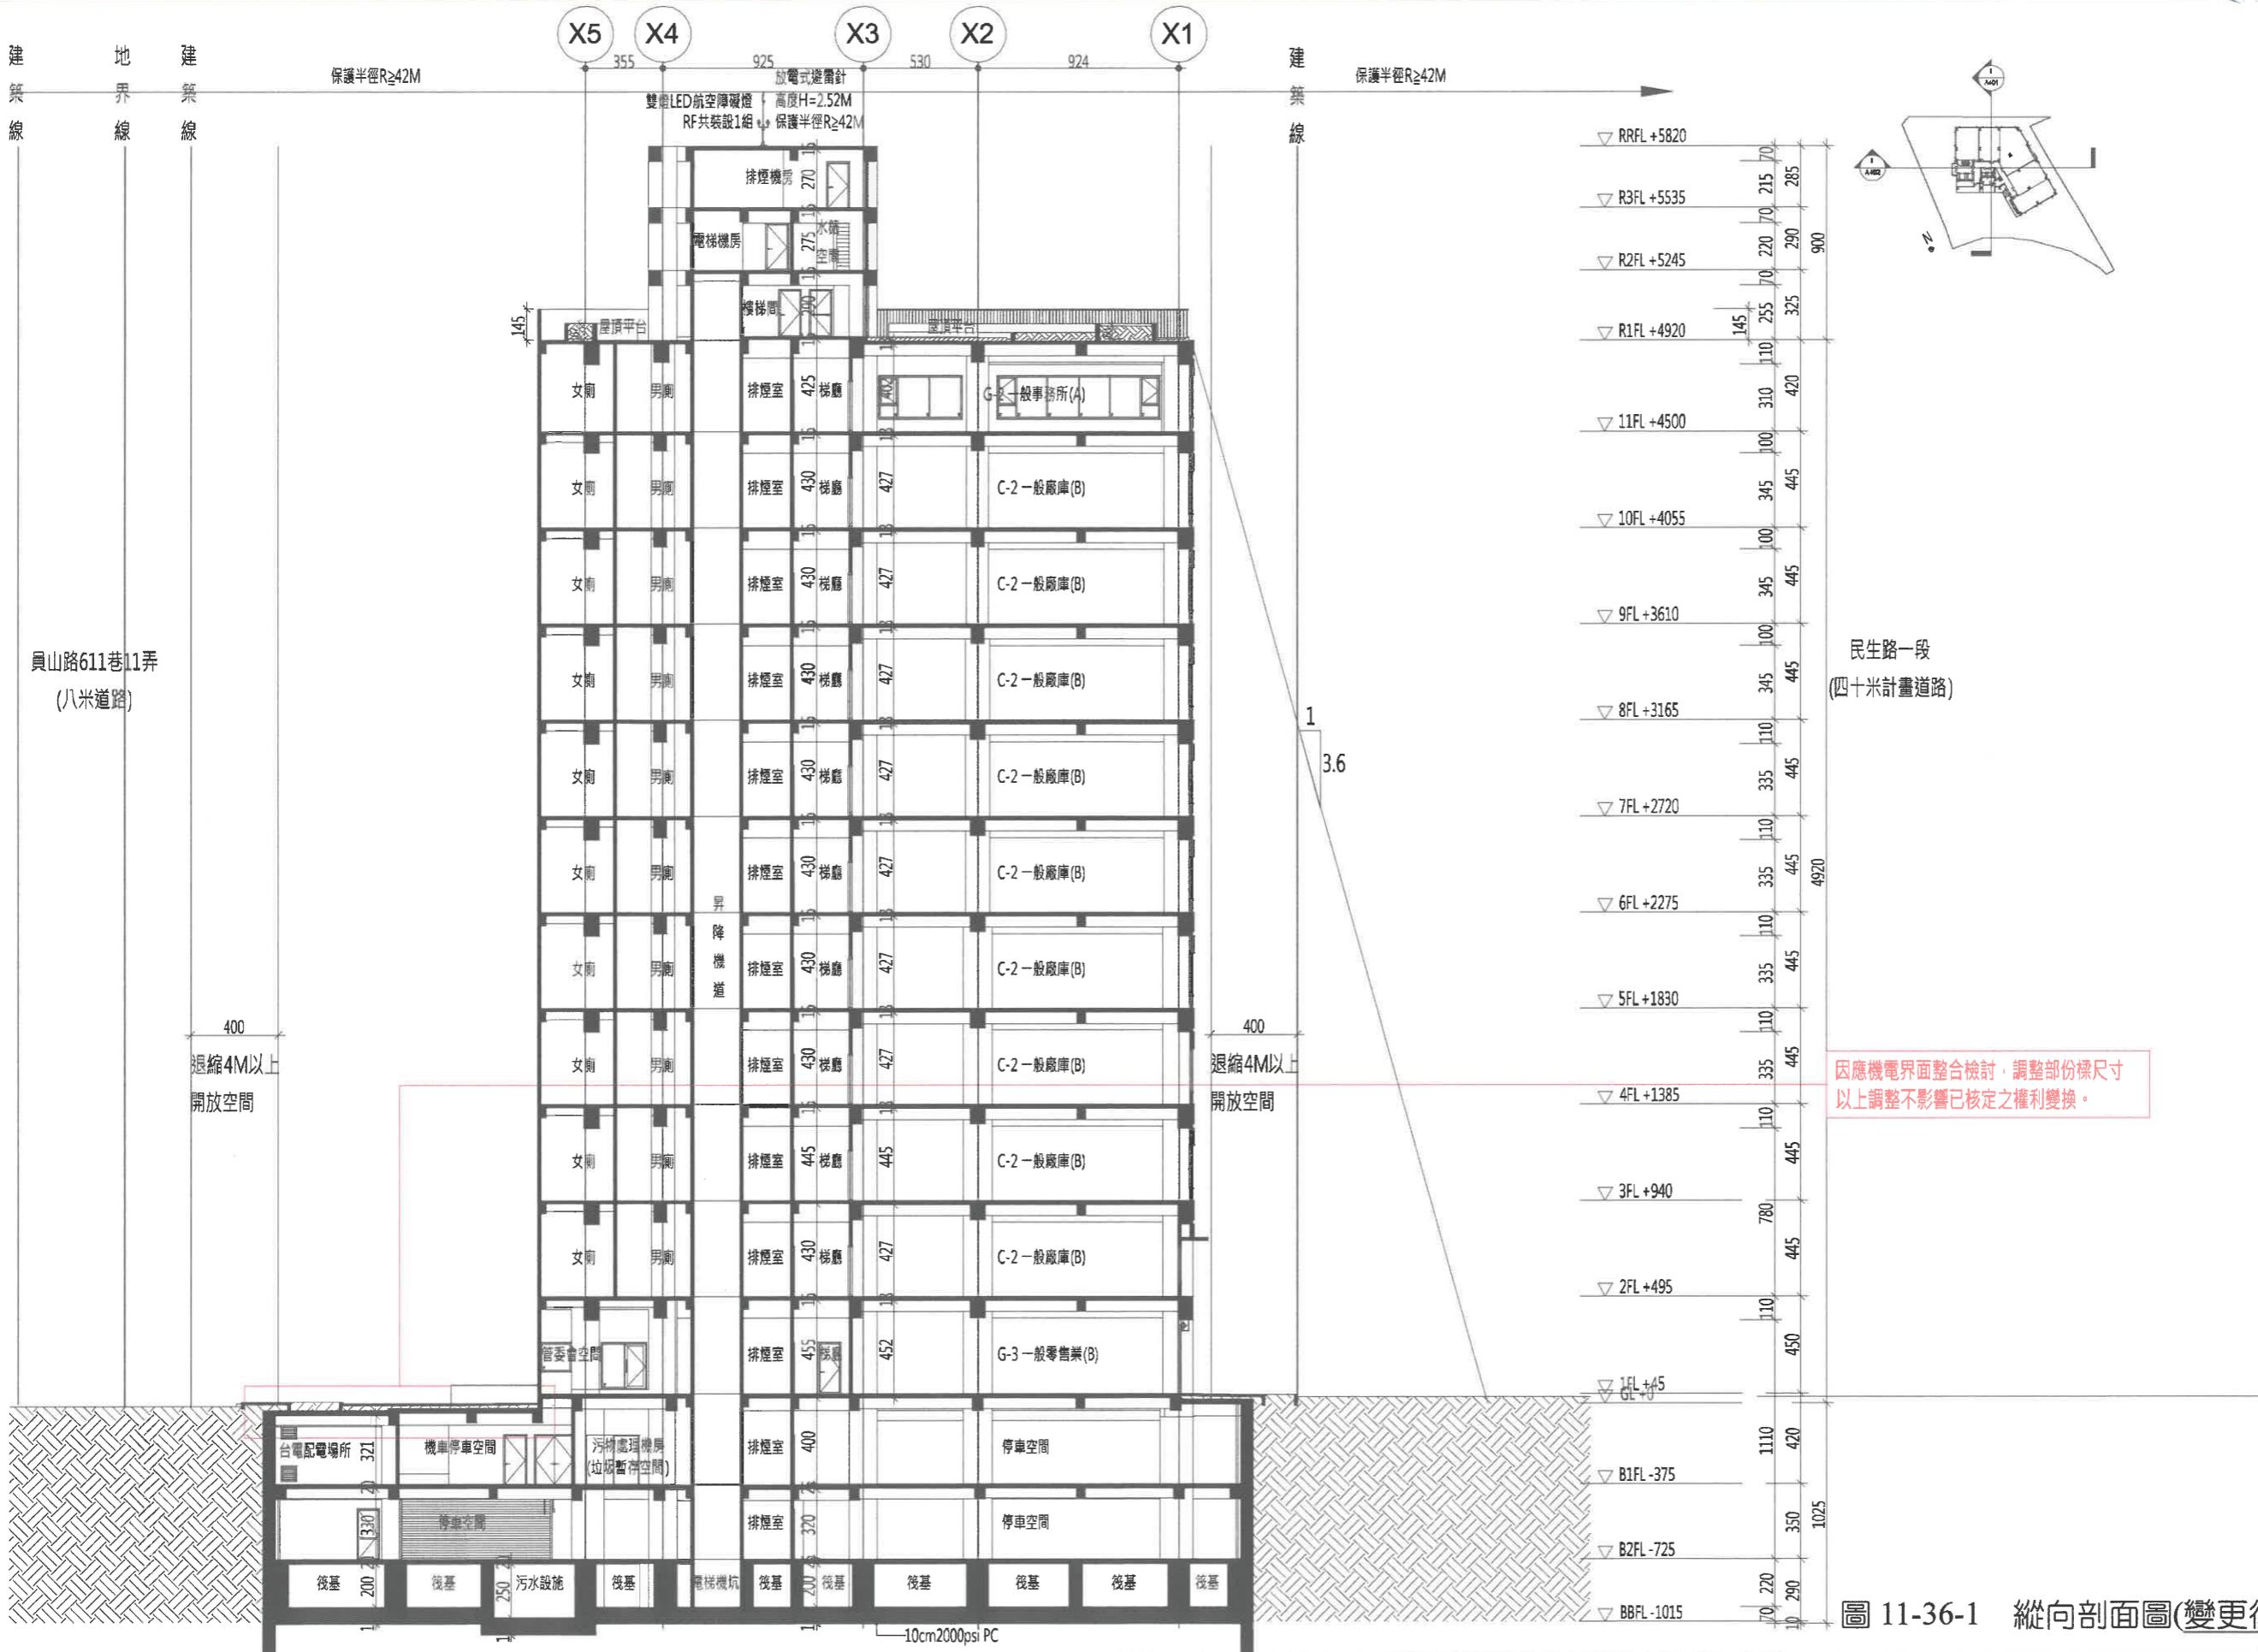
縱向剖面圖(變更後)(S : 1/300)
